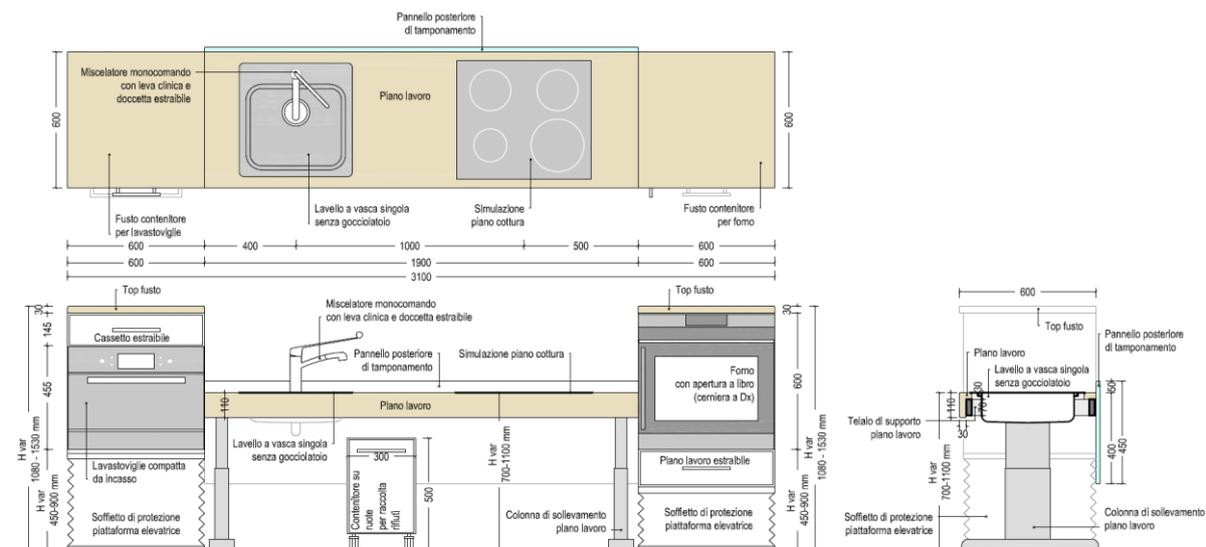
Pianta, prospetto frontale e sezione Blocco Preparazione
